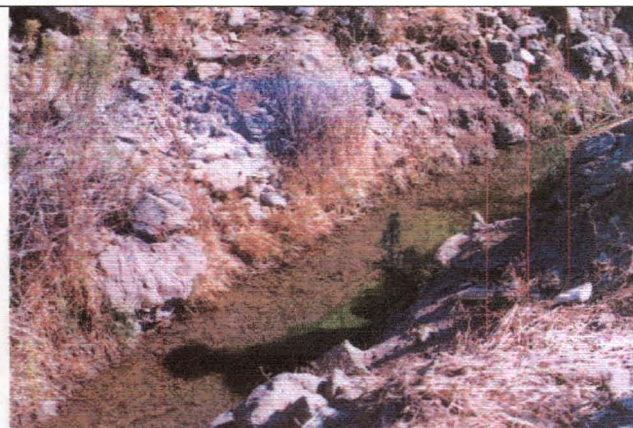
Caída de quebrada al canal. Se observa embanque de la quebrada en el canal y sección de ancho irregular.
